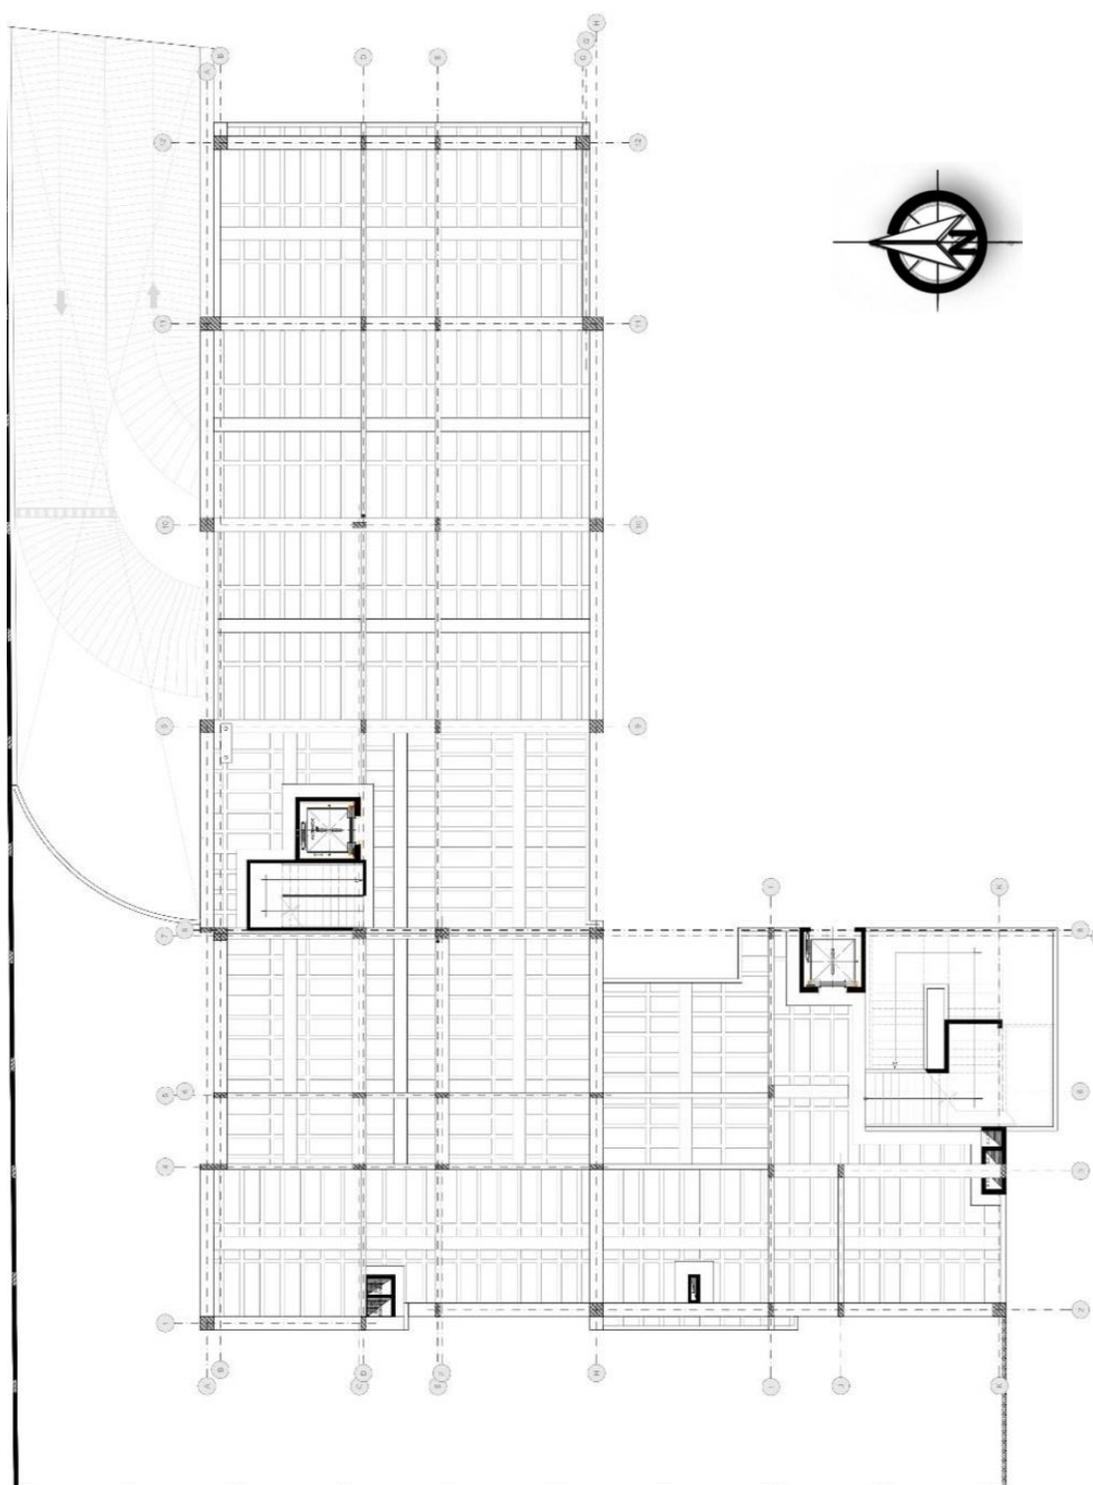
Planta estructural entrepiso piso 1 N-1.04*PLANTA ENTREPISO
